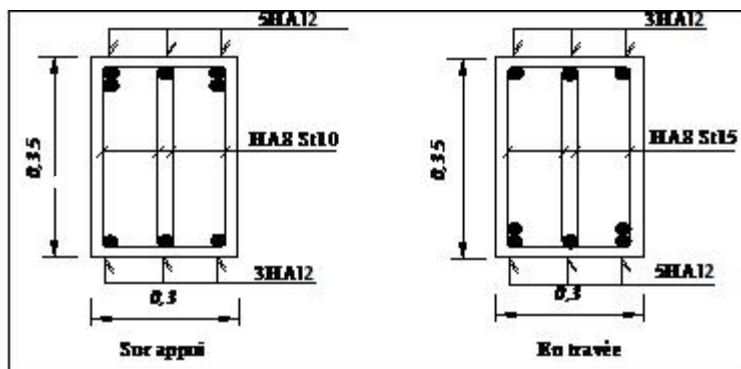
Schéma de ferrailage des poutres secondaires.
